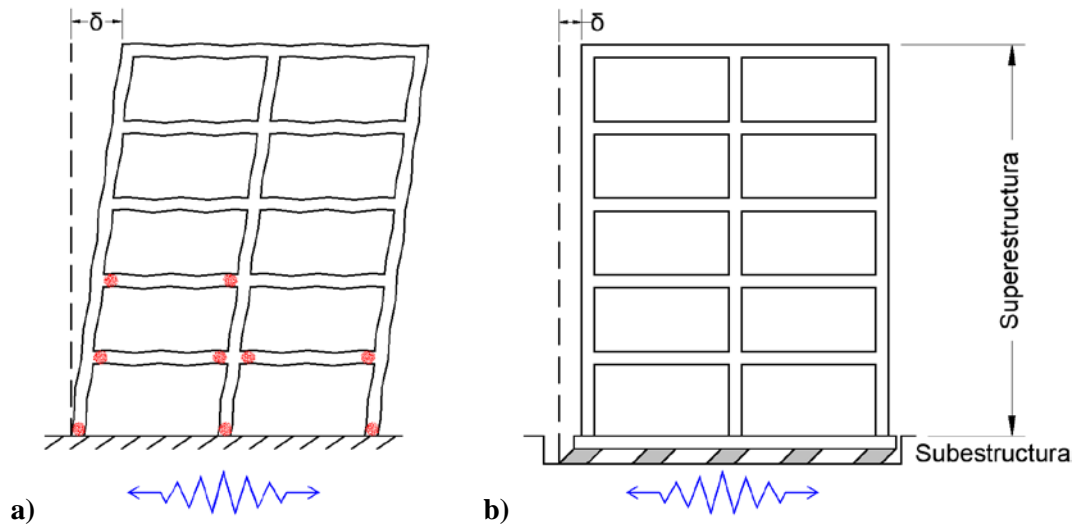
a) Edificio convencional y b) Edificio con aislamiento sísmico
